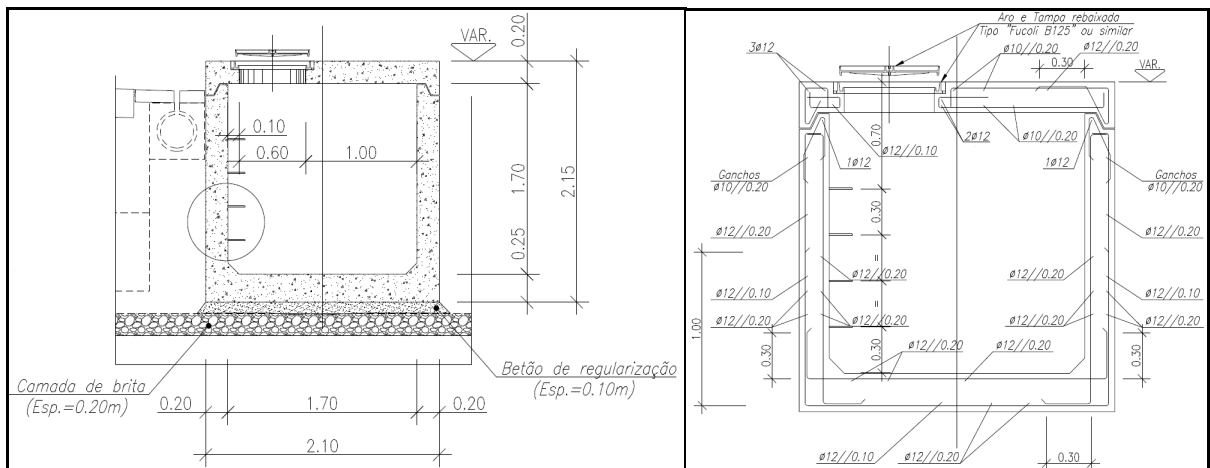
Corte-tipo da Galeria Técnica – geometria e armaduras (imagem do projecto de execução).
